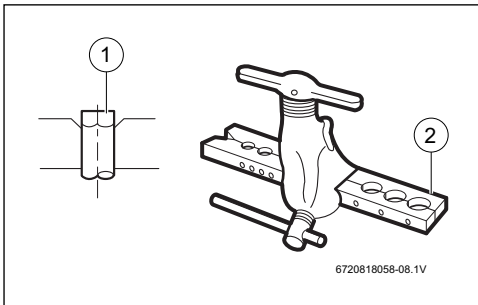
Préparation de l'élargissement des extrémités du tube en cuivre
